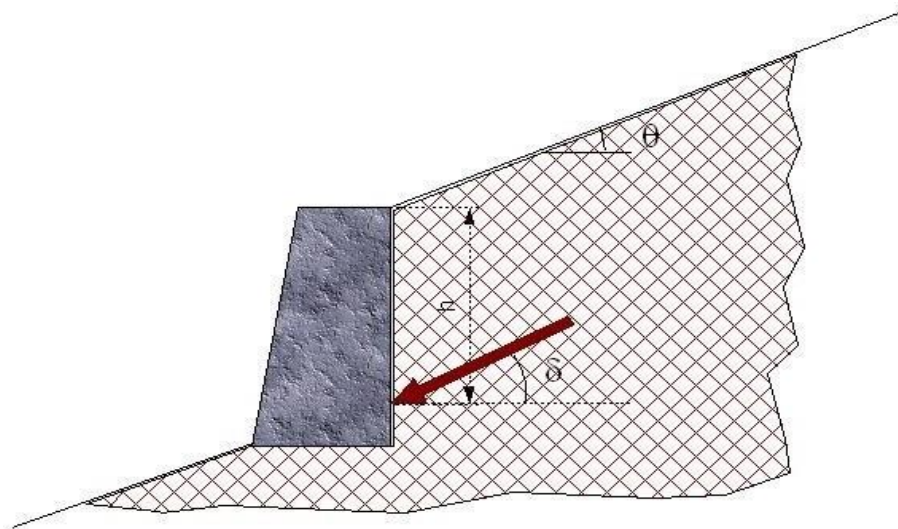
Force de poussée agissant sur un mur de soutènement
